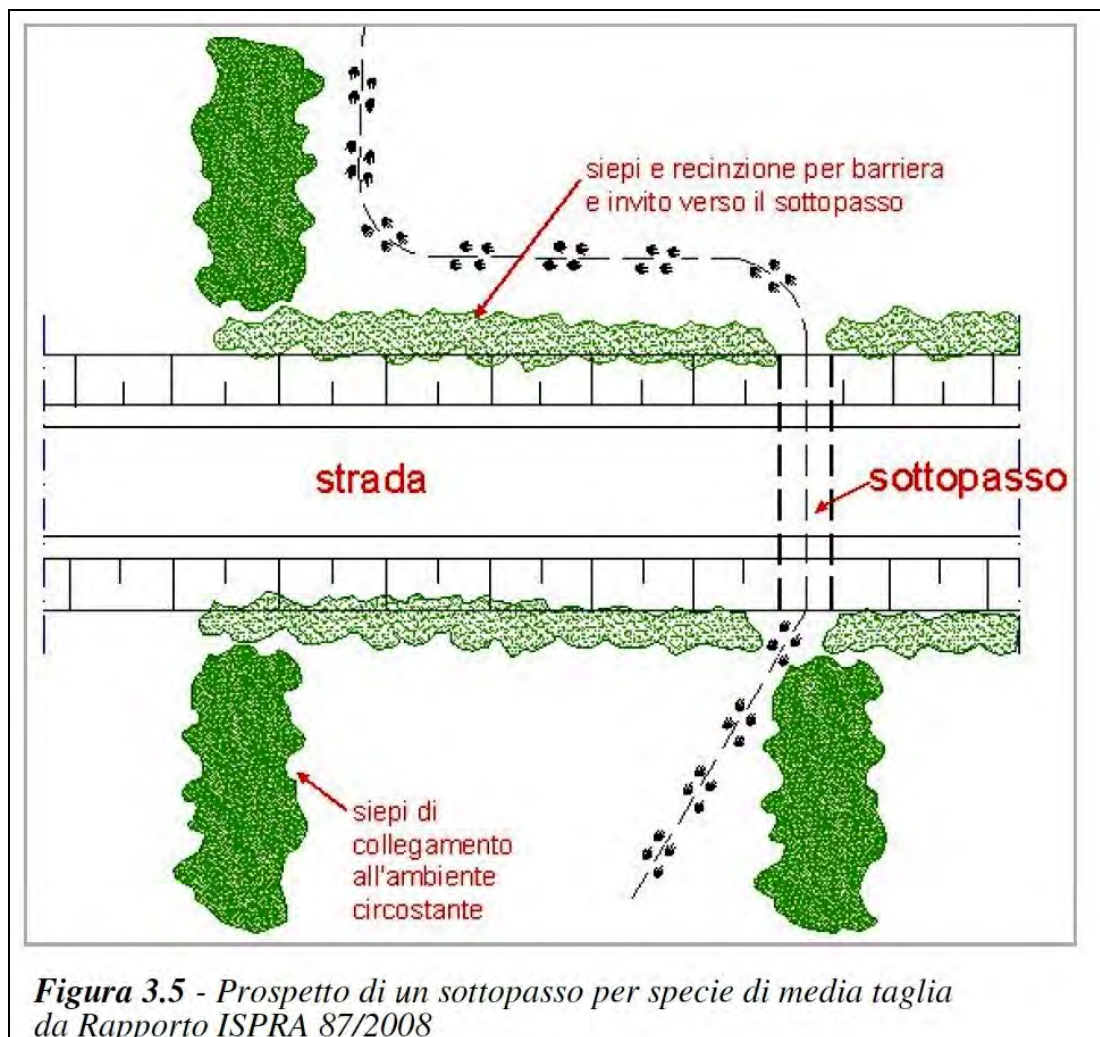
Prospetto di un sottopasso per specie di media taglia da Rapporto ISPRA 87/2008
